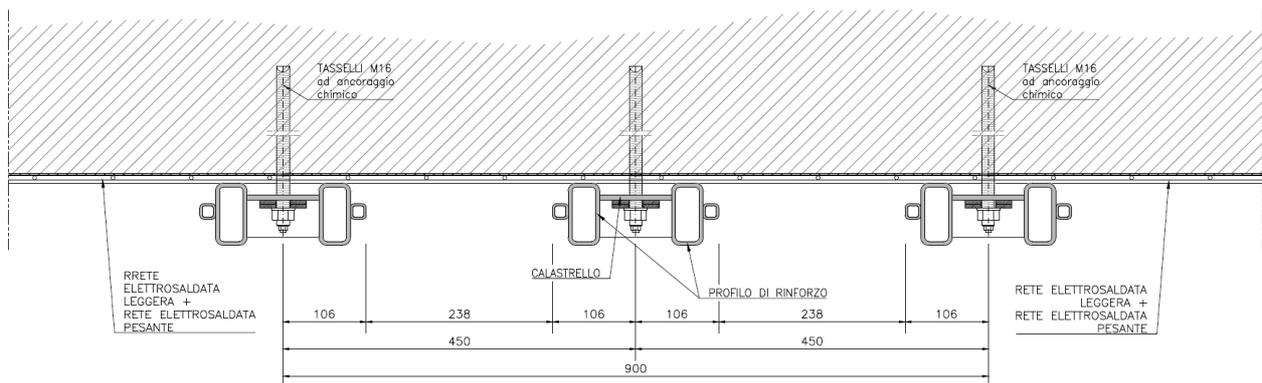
Sezione longitudinale configurazione profili - FASE 2
